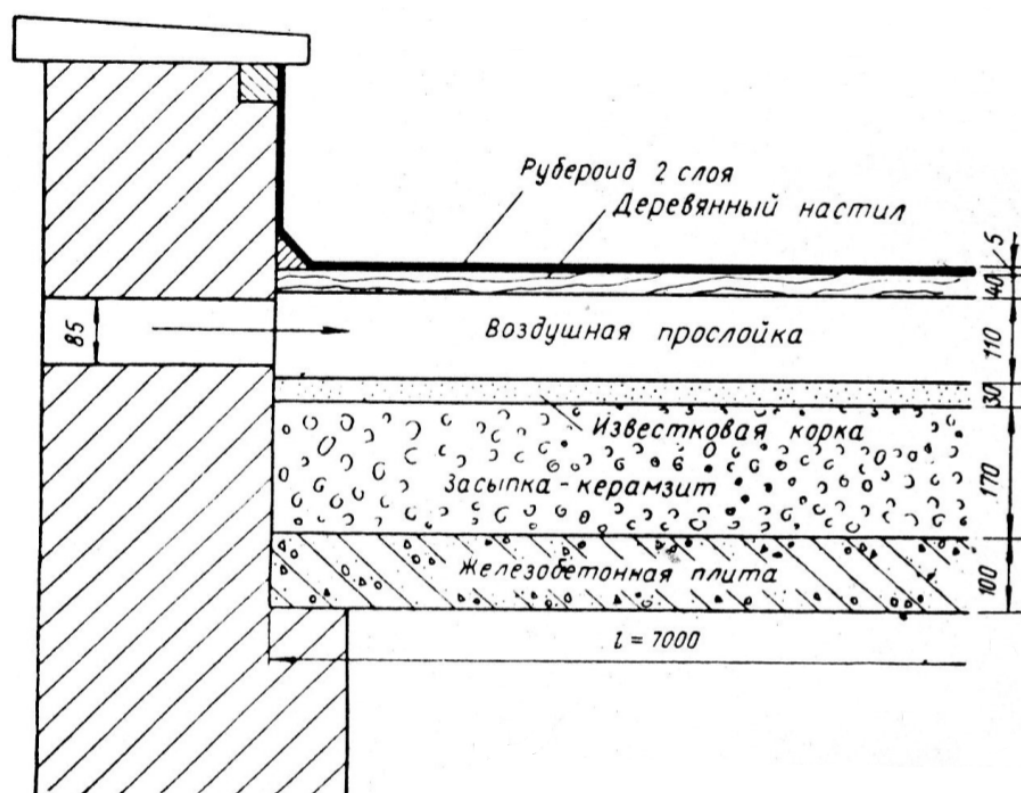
Совмещенное покрытие с вентилируемой воздушной прослойкой.
